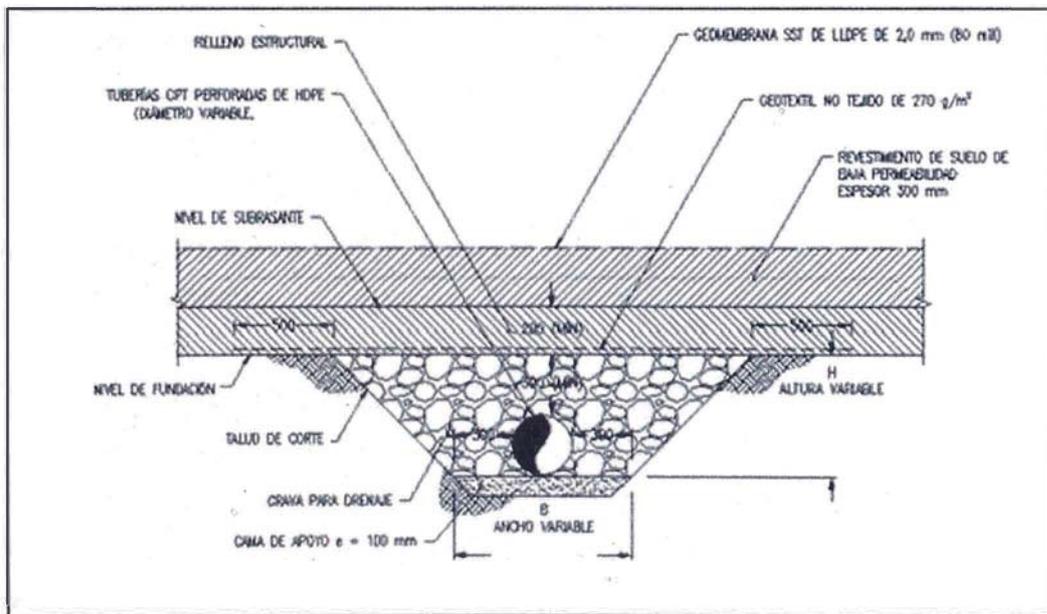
Detalle del sistema de sub drenaje en laderas.
